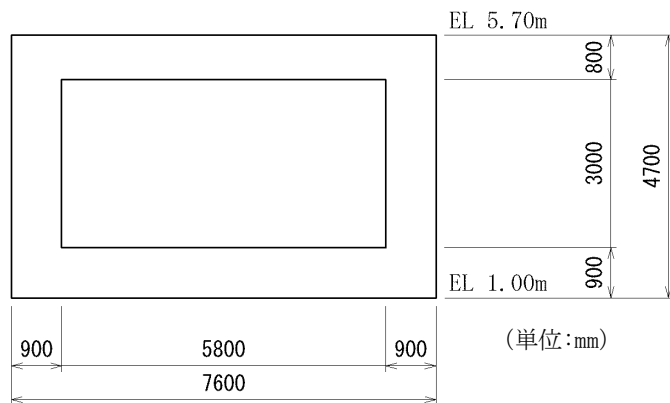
屋外配管ダクト (タービン建物～放水槽) 断面図 (C-C 断面)
